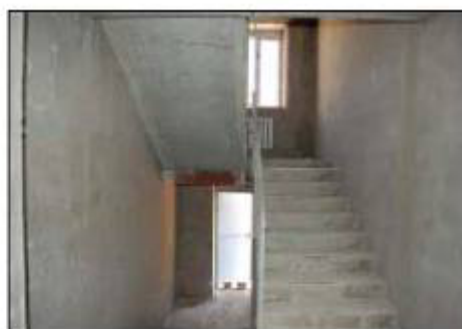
| Blok IV - Wejście 13/1 - Klatka 6
